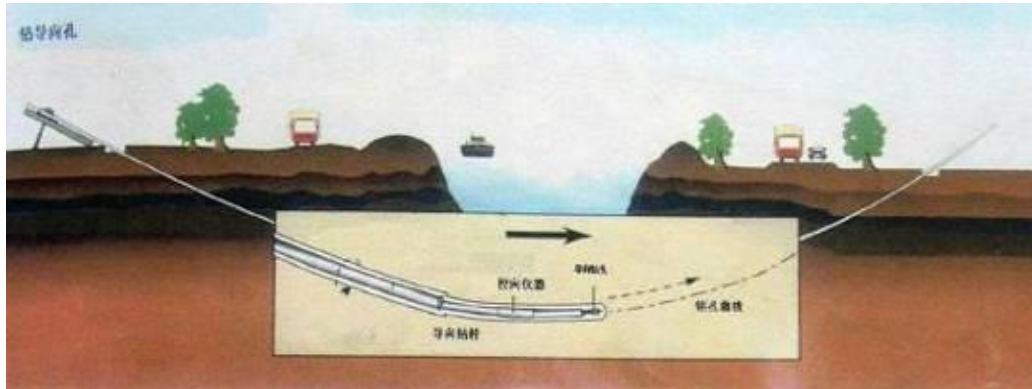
定向钻穿越施工钻导向孔过程断面示意图
